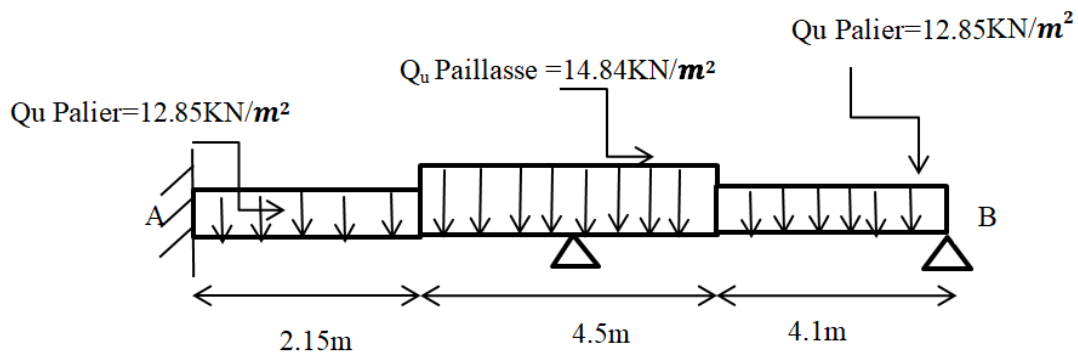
Schéma statique d'un escalier à paillasse avec palier de repos à l'ELU.
